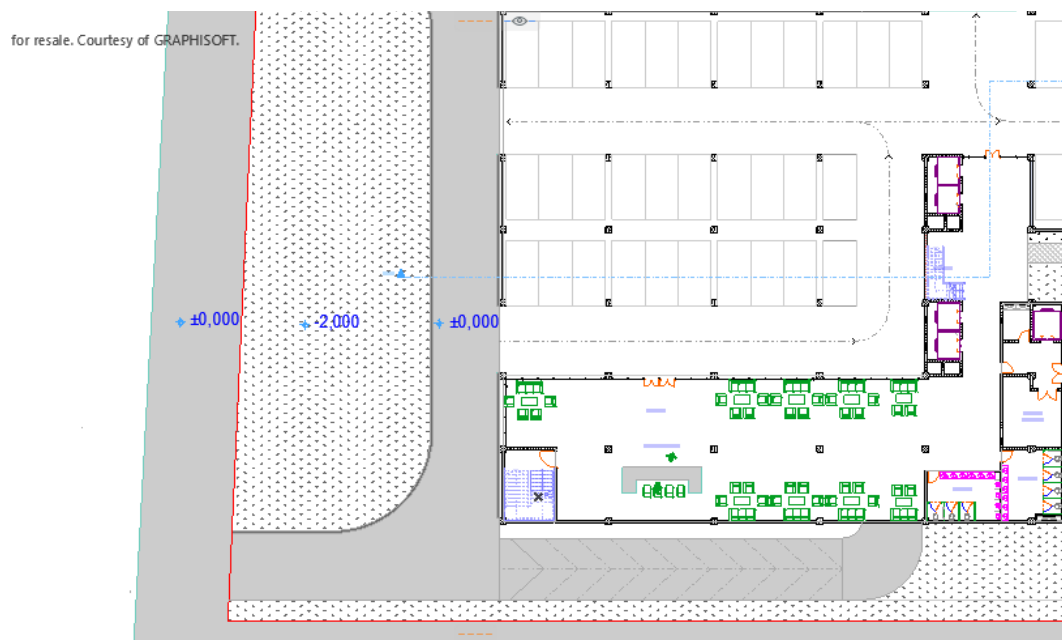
Zoning Bangunan Secara Vertikal
